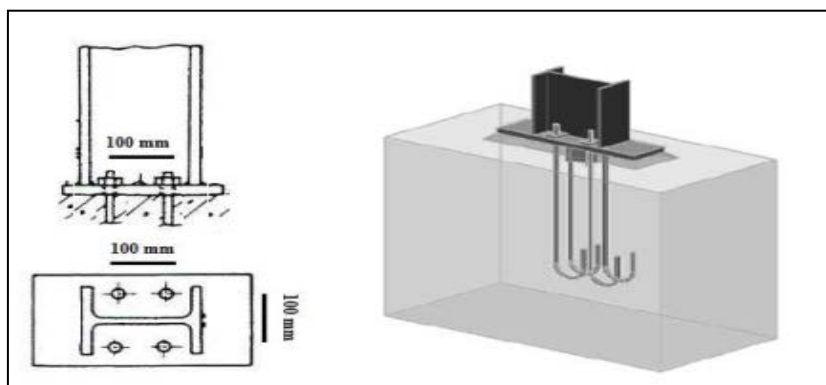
Pied de poteau articulé avec 04 boulons d'ancrage.
